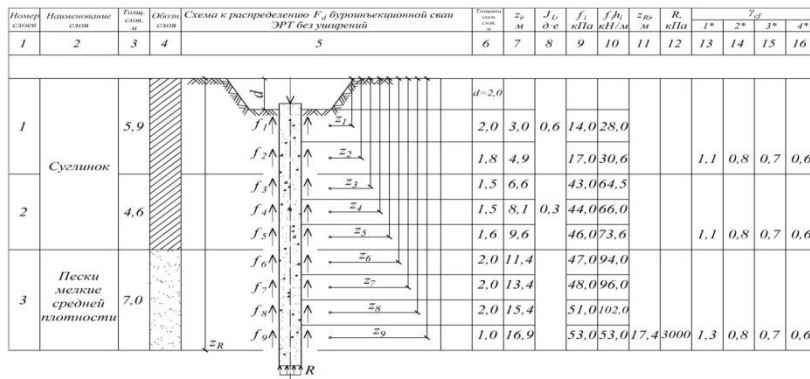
Схема к определению несущей способности Fd буровых свай: 1\* - Для буровых свай ЭРТ без промежуточных уширений; 2\* - Для буронабивных свай при погружении инвентарной трубы с теряемым наконечником; 3\* - Для буронабивных свай с использованием обсадных труб или проходных шнеков; 4\* - Для буронабивных свай, выполняемых под защитой глинистой рубашки. Коэффициенты γ<sub>ср</sub> взяты из табл. 7.6 СП 24.13330.2021.
